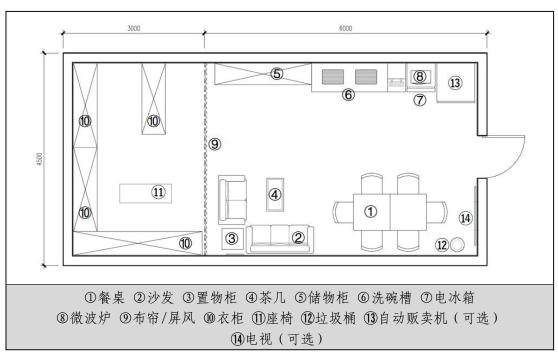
航站区共享休息区+更衣室平面示意图(单位: mm)
